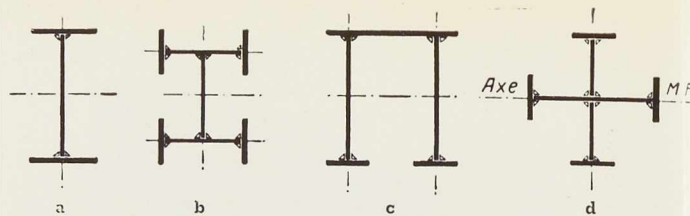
Section type des membrures de ponts soudés du type Vierendeel construits en Belgique.
